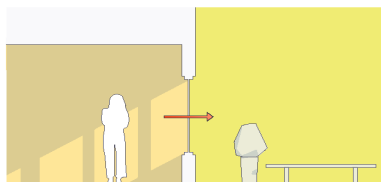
Acristalamiento fachada noroeste. Elaboración propia.
